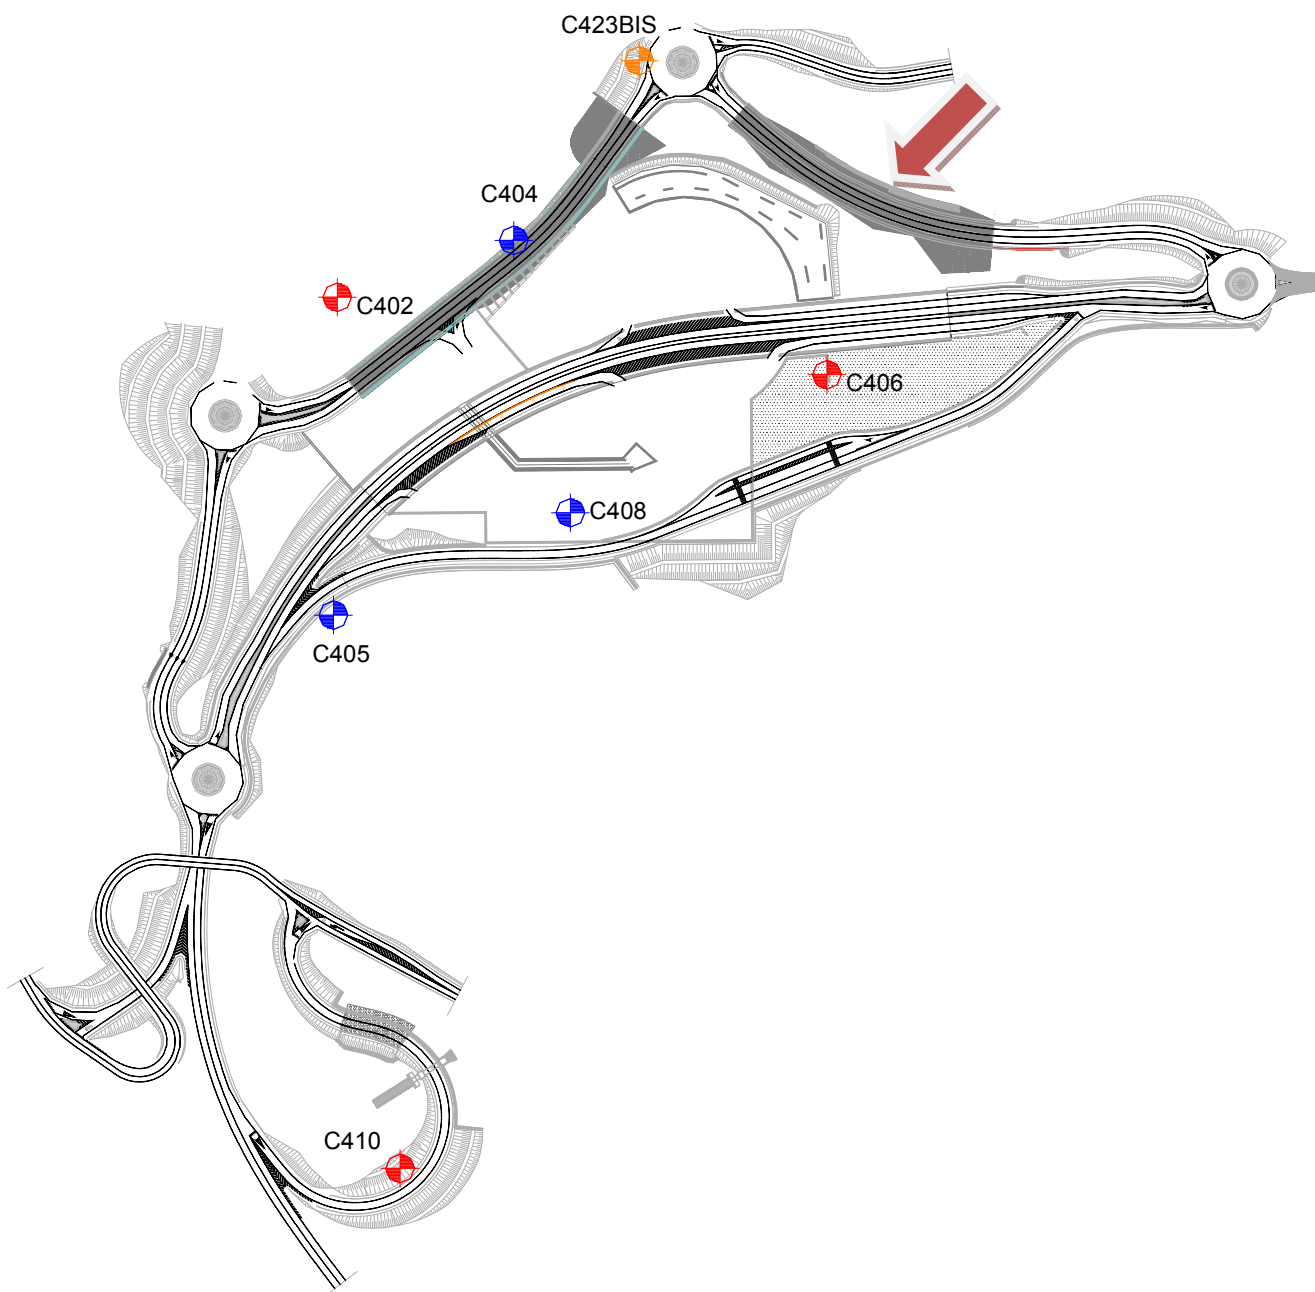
Stralcio planimetrico con ubicazione delle opere e dei sondaggi
